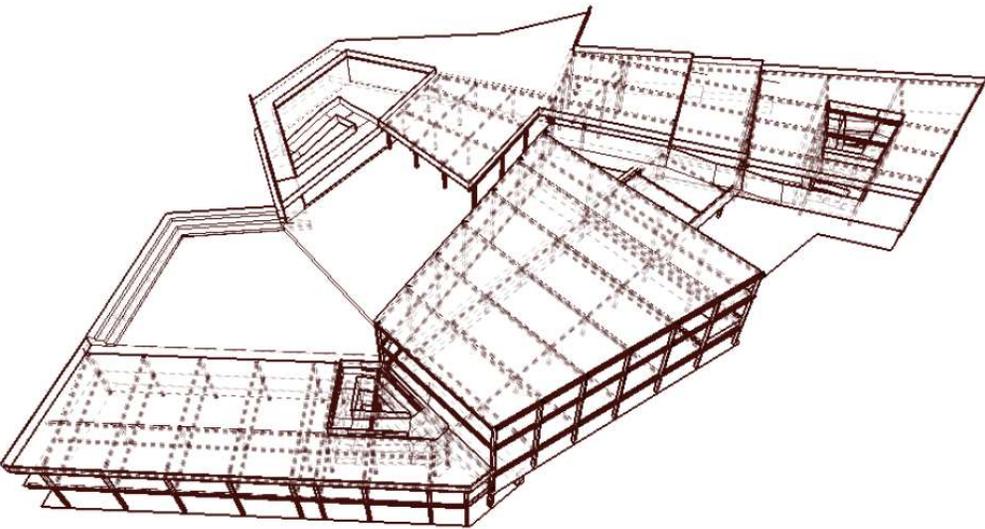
Vista de conjunto arquitectónico Sur-Oriente. (Elaboración propia, 2018)
